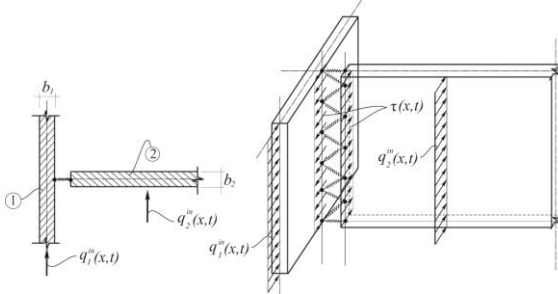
Схема расчета напряжений в стыковых соединениях наружных продольных и внутренних поперечных стен:
